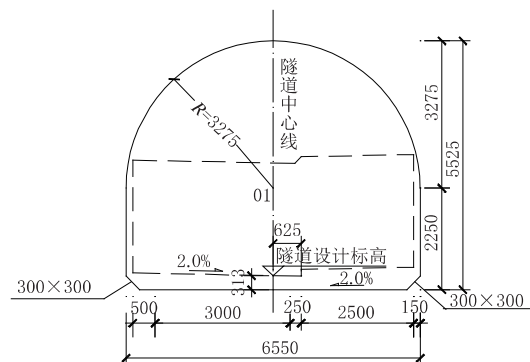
B1、B4 隧道内轮廓横断面图(单位: mm)
